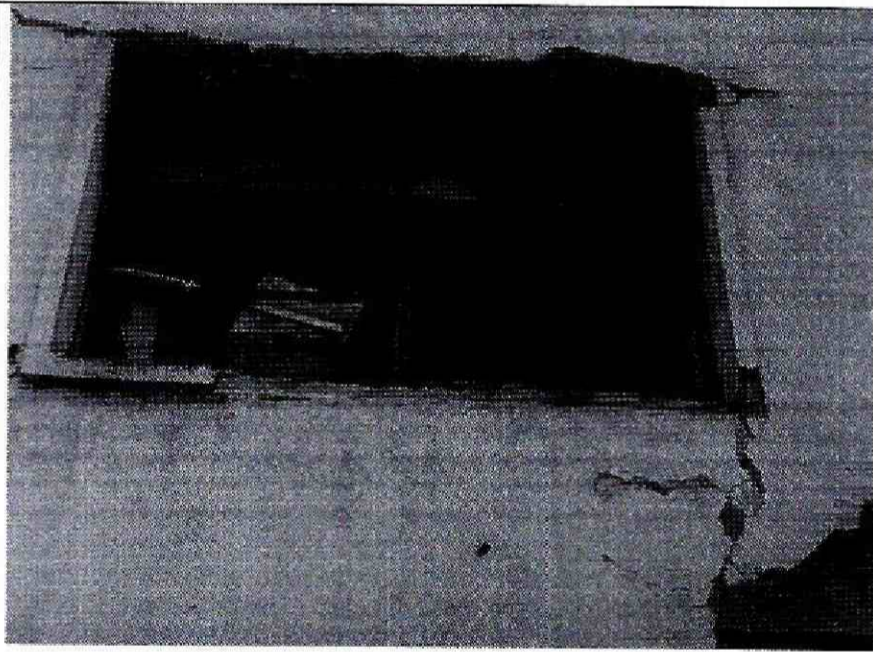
Grietas y desprendimientos de materiales en los muros de fachada.
